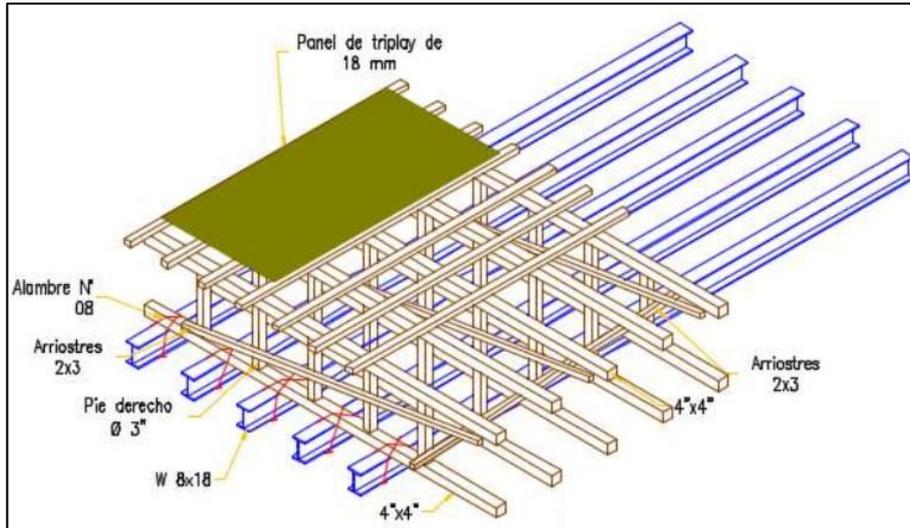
Vigas longitudinales y encofrado para losa inferior.
